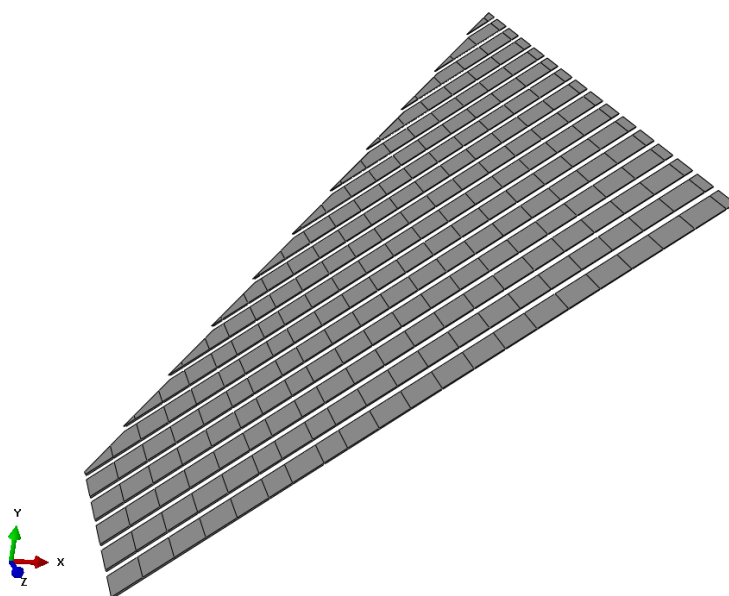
Geometria 3D aberta das faixas na laje de concreto a cada 16 m.
